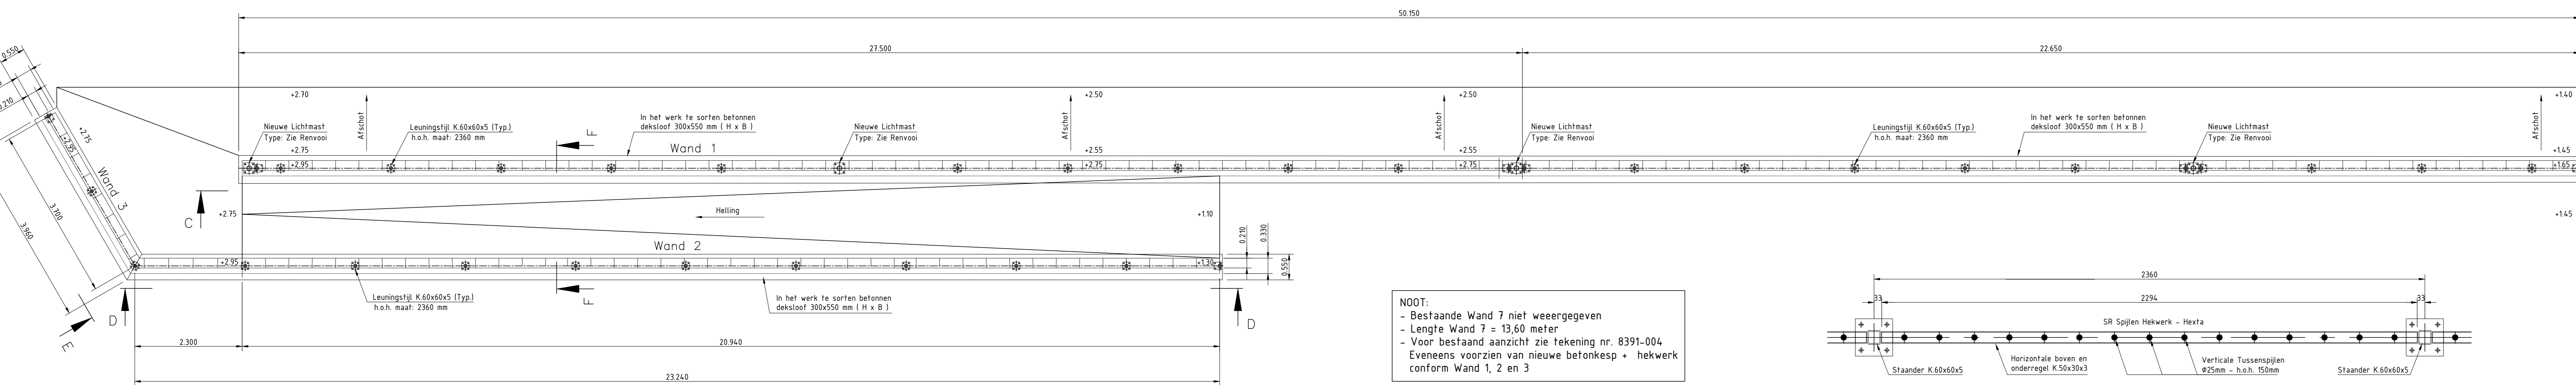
VORM+WAPENING BETONNEN DEKSLAOF
